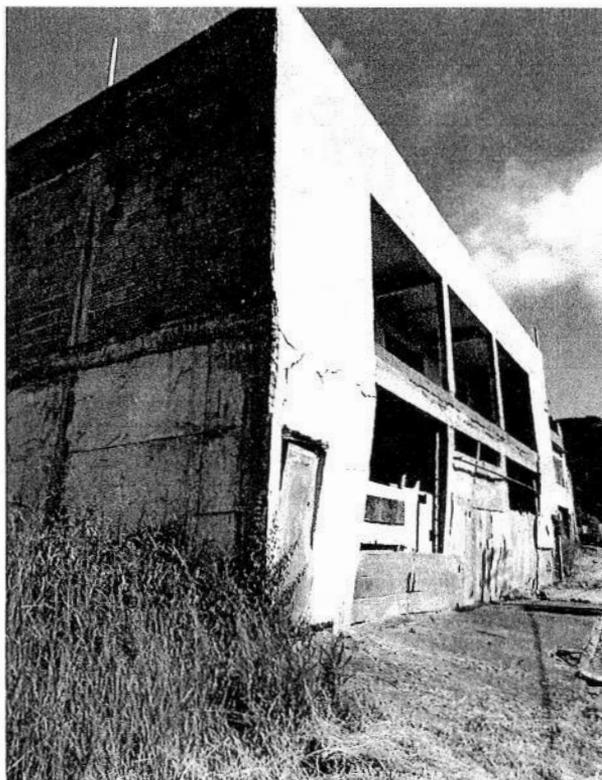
Rachaduras na fachada em 03/03/2022, casa s/n
